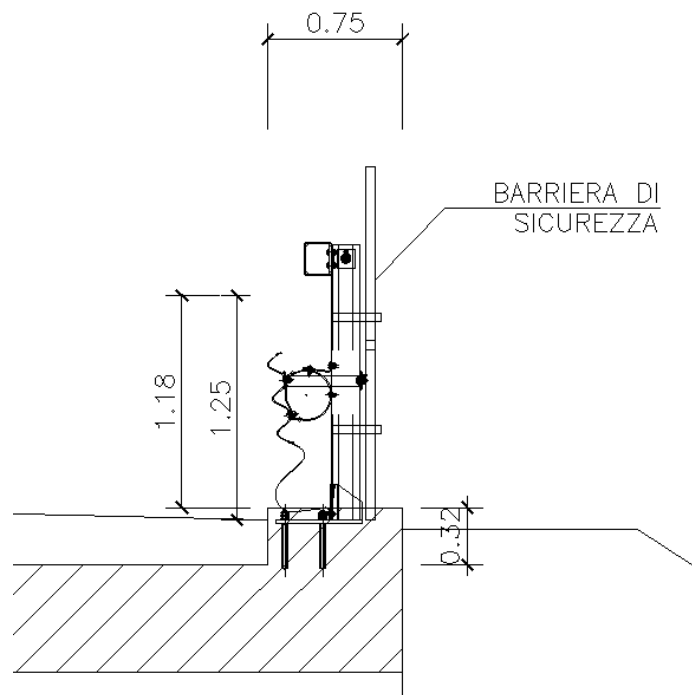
Sezione muro porta barriera con barriera di sicurezza
